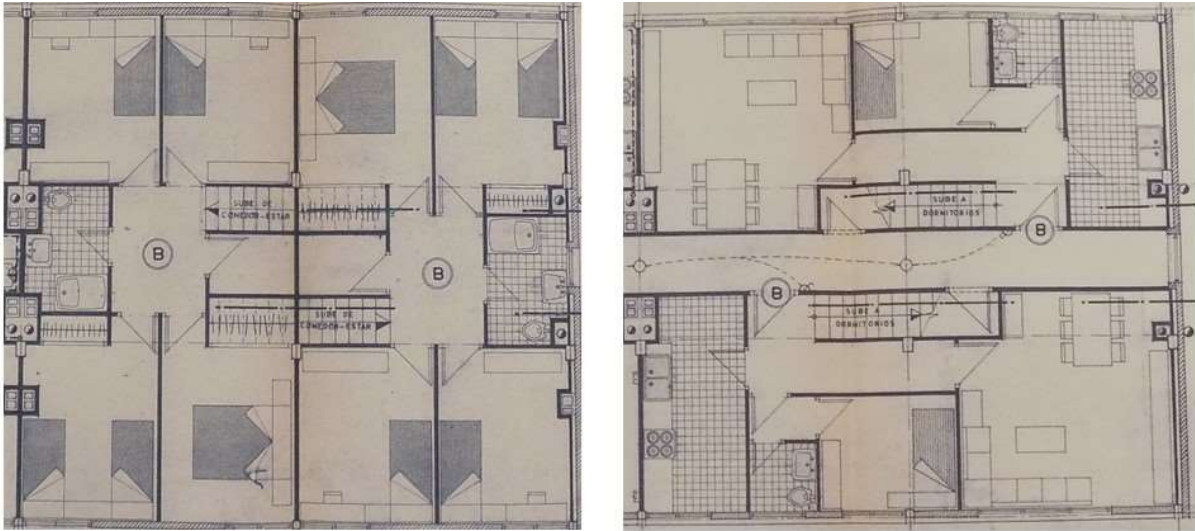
Plantas tipo de vivienda. A la izquierda, la zona de noche pasante de fachada a fachada, a la derecha, la planta de acceso desde el corredor. Obsérvese como las plantas de una misma vivienda se contrapean en altura. Fuente: AMS
